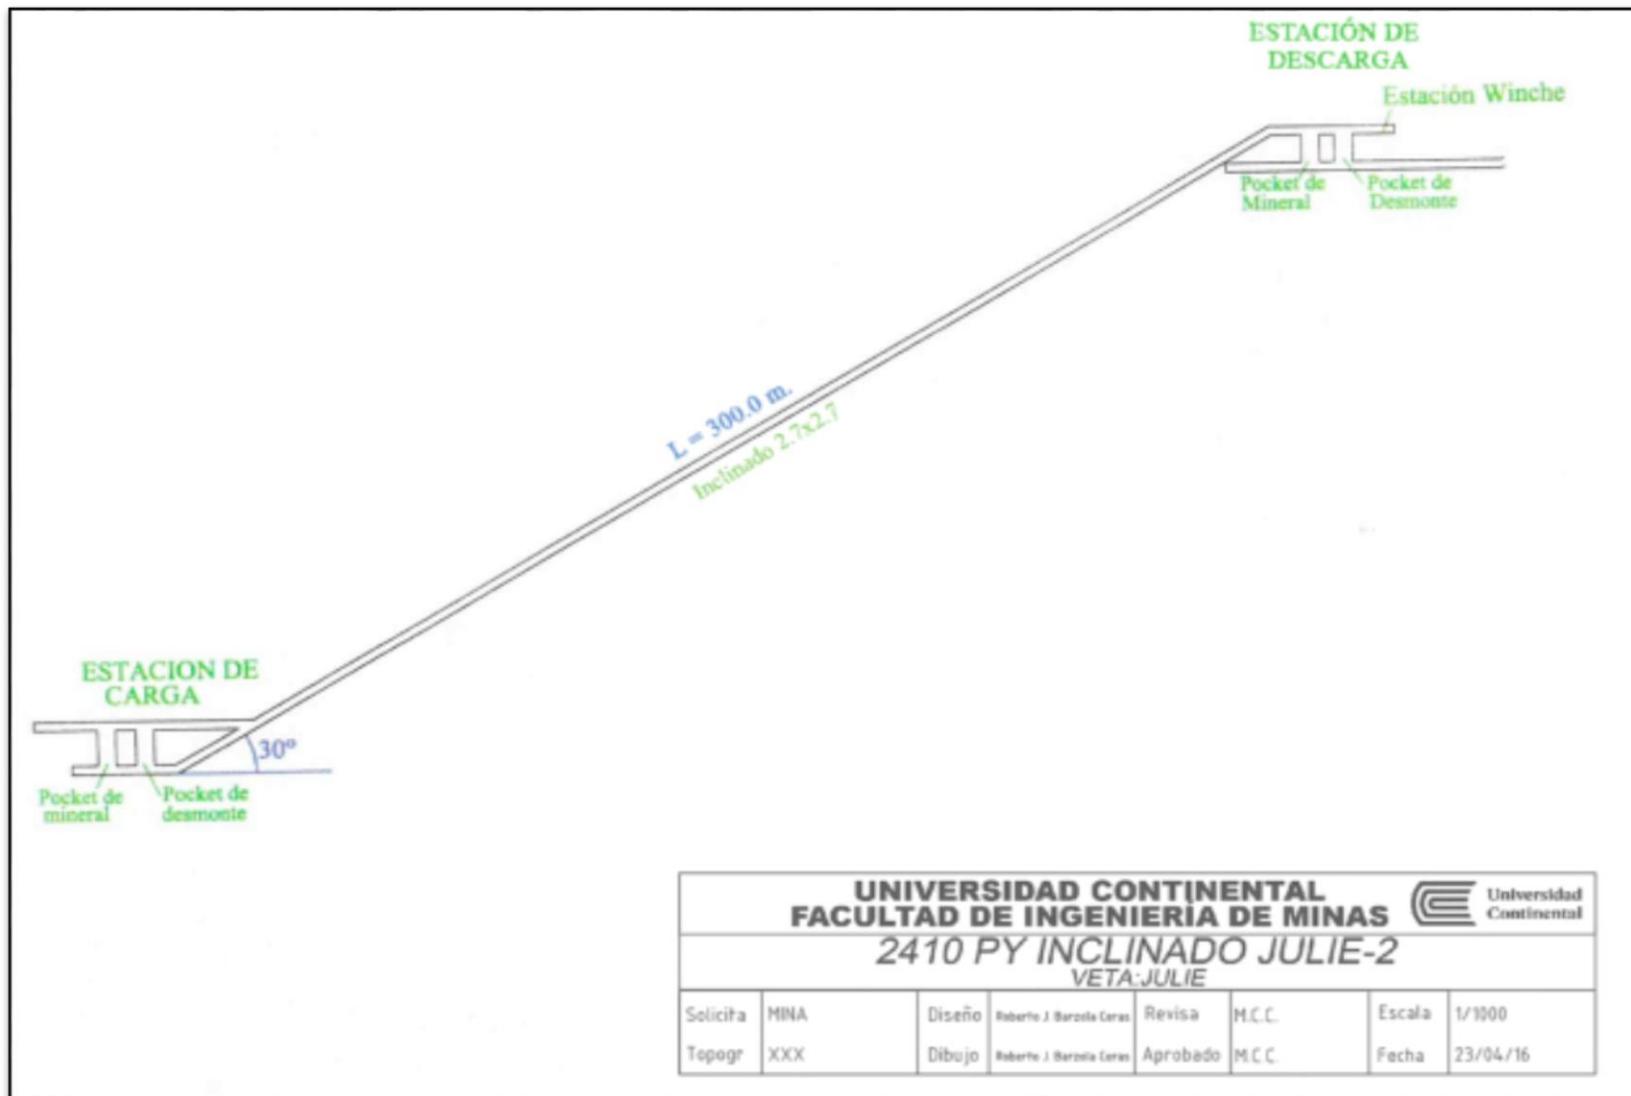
Plano Inclinado Julie – 2 Estación de carga y descarga
